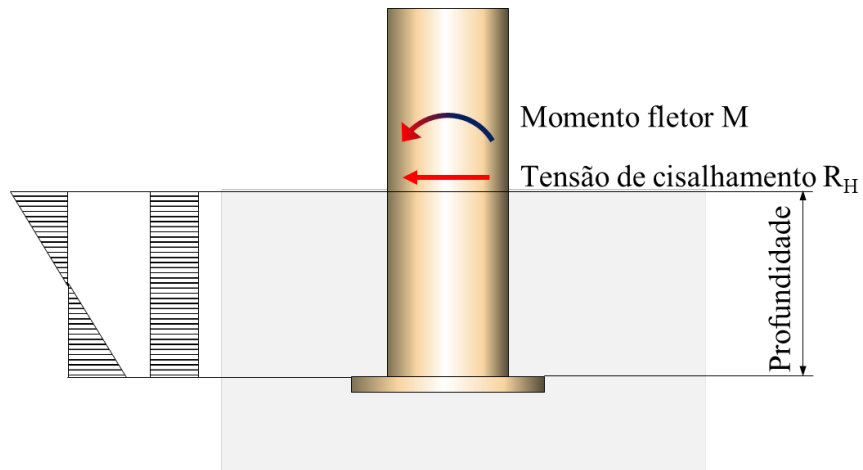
Tensões normais no concreto devidas às reações de apoio horizontal H e momento M
